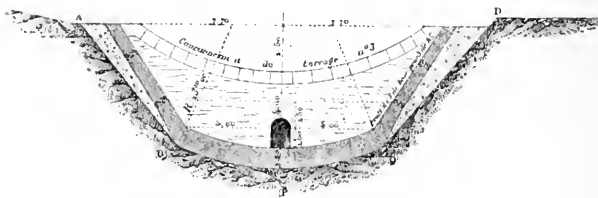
Coupe sur la tête du radier et des murs suivant le profil en travers n° 2.
